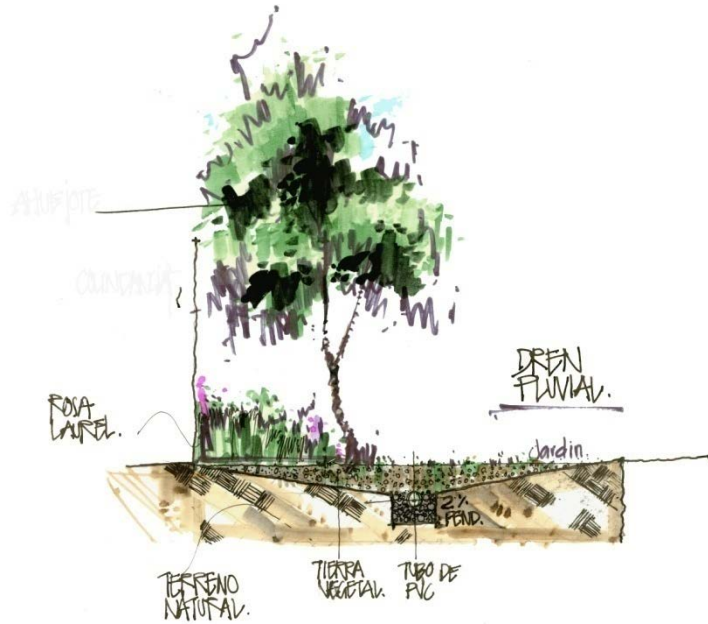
Croquis del dren pluvial colocado en la parte posterior de las viviendas. Croquis.
